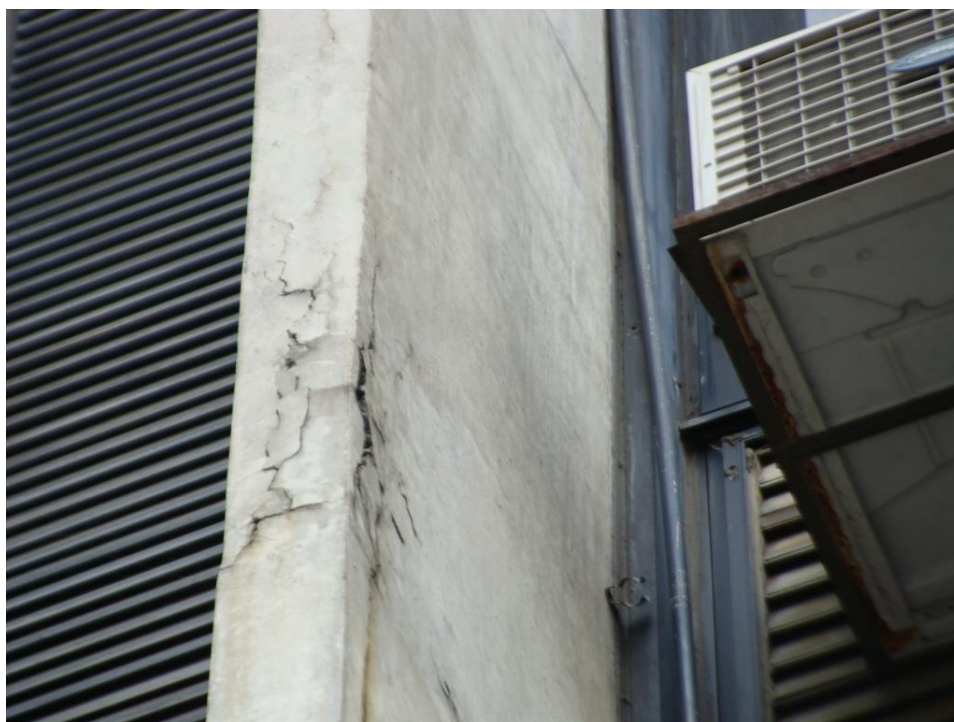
Armadura exposta pilar P12 (2º pavimento) (02/03/2021)
